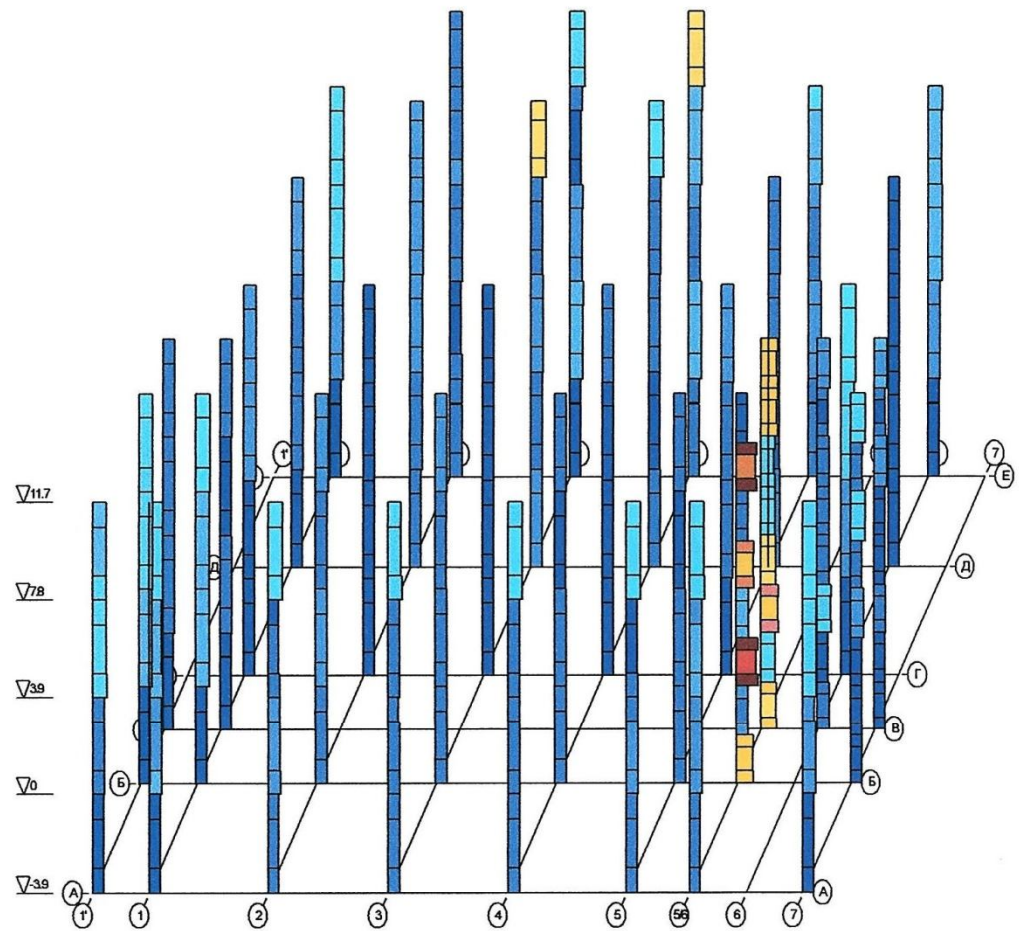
Необхідні площі поздовжньої арматури у колонах перетином,
